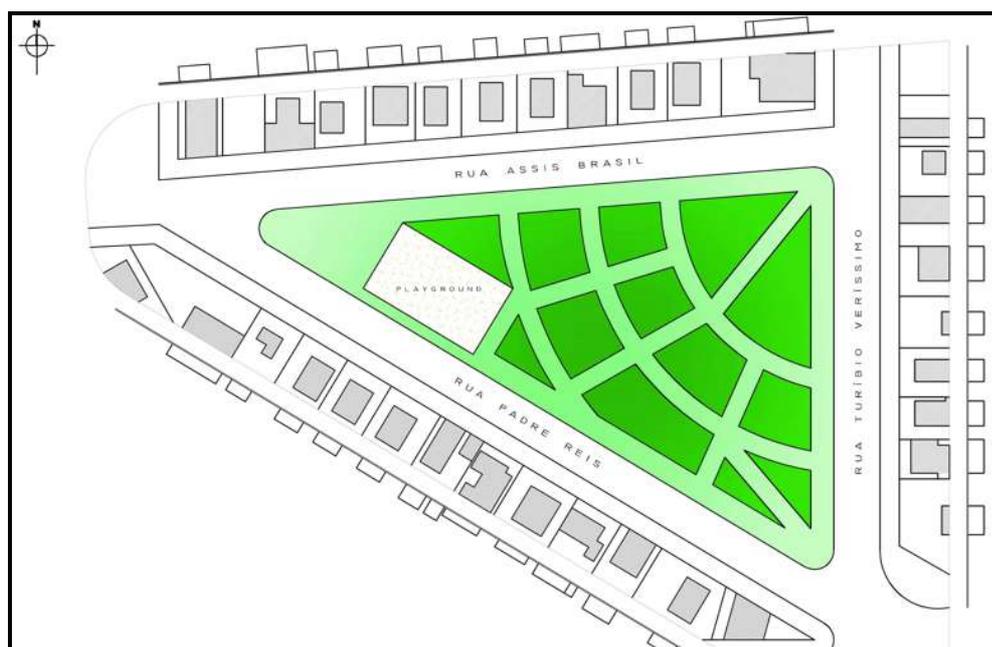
Planta Baixa da Praça Gal. Rondon e entorno.
